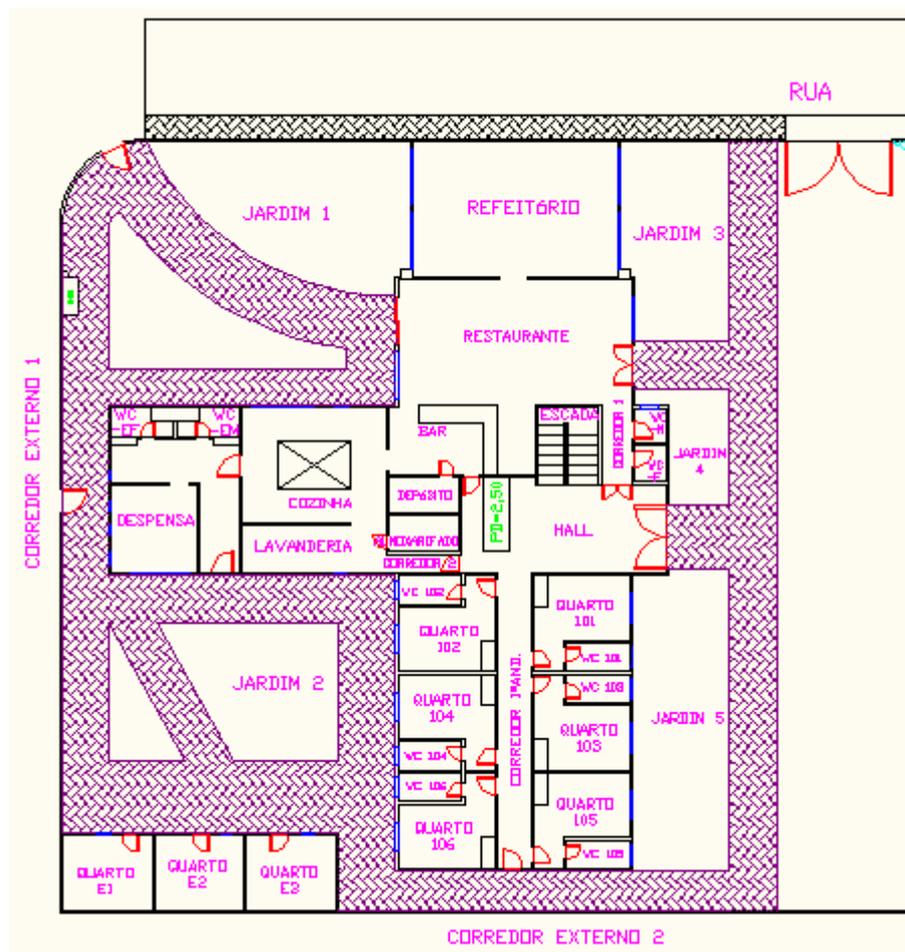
Planta baixa das dependências e acessos ao primeiro pavimento
